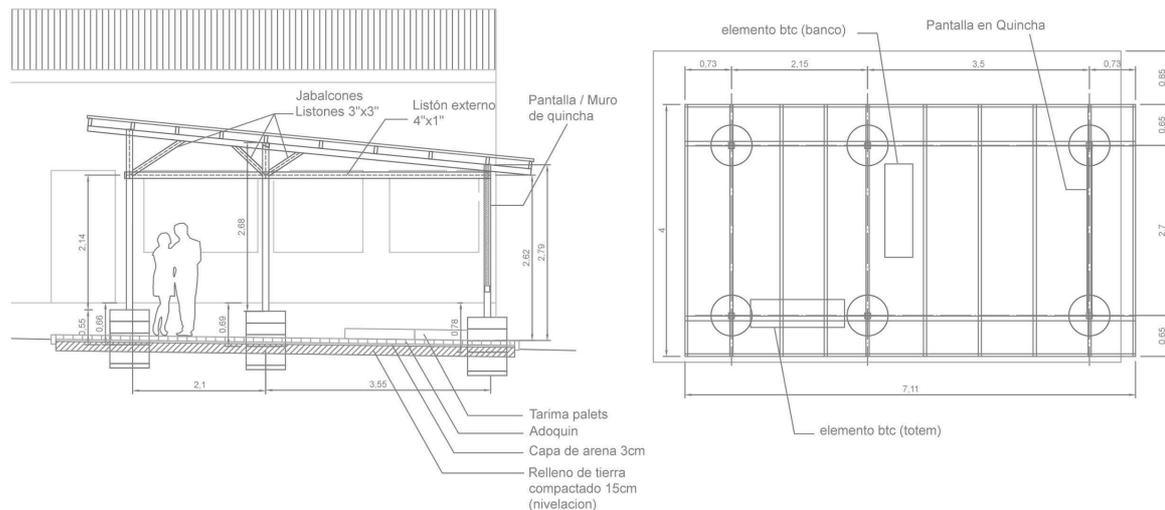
Planimetría del CinemaTerra. Fuente: Taller Tierrabaja 2017
